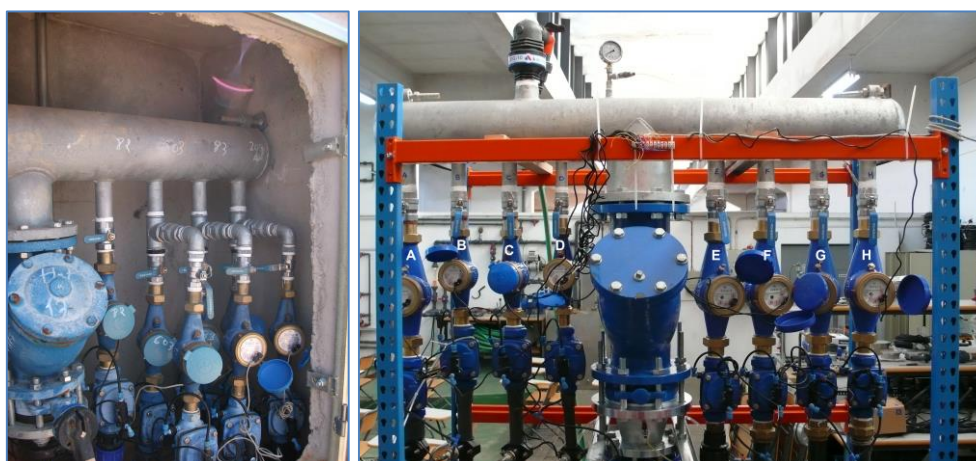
Hidrante vertical V2. C.R. Los Tollos 2012. Tipo 1. (Fotos Balbastre I.). Filtro caza piedras mal colocado, ventosa sin válvula de aislamiento, tomas muy justas.
